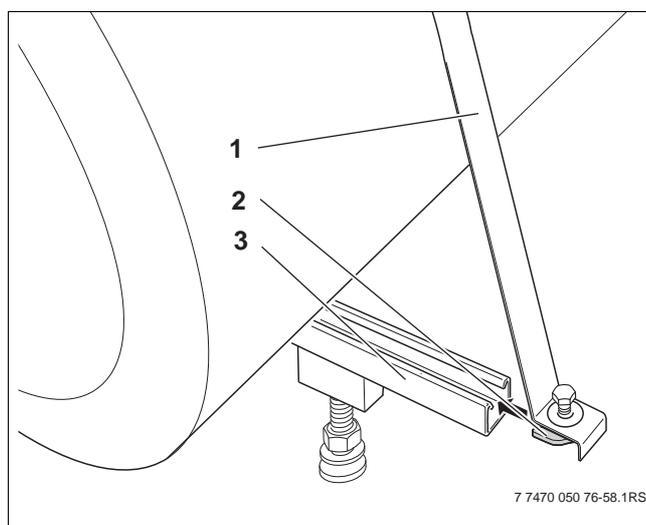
Vista da instalação para telhados inclinados (aqui, sistema de 300 l)
